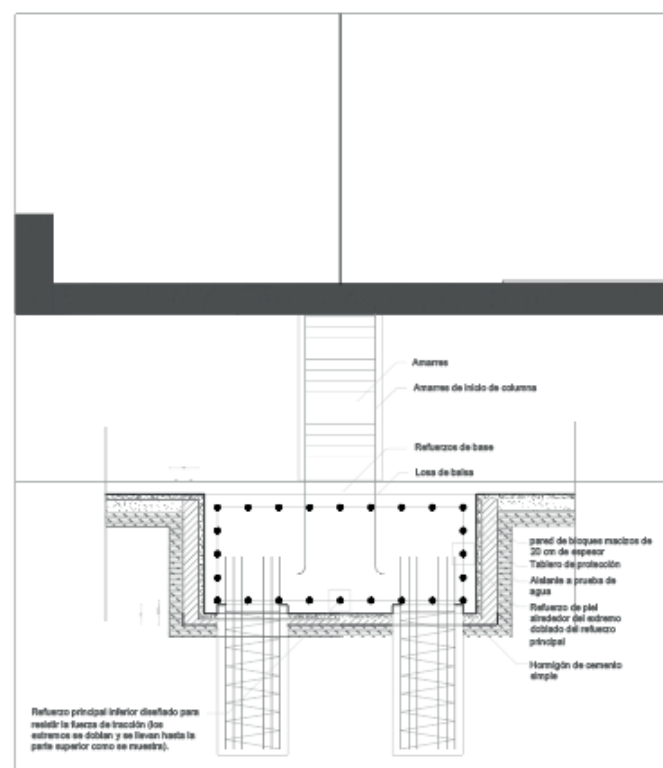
Detalle pilotes. Fuente: Elaboración propia. 2025
